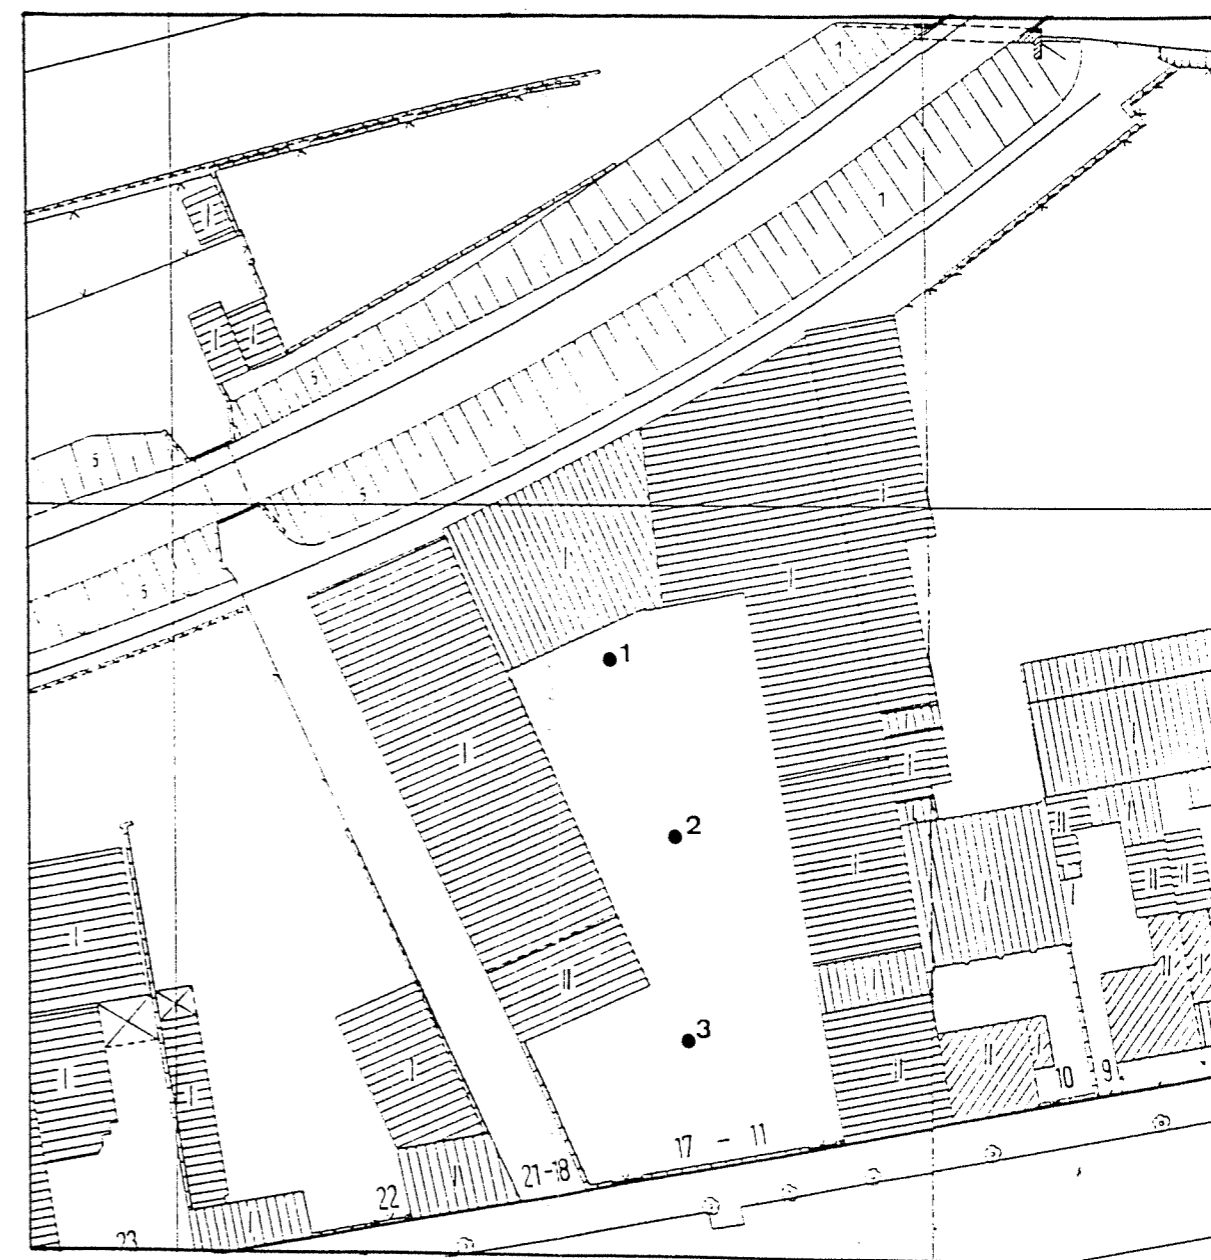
e.: Verdachtsfläche 4 - Bohrpunktplan
